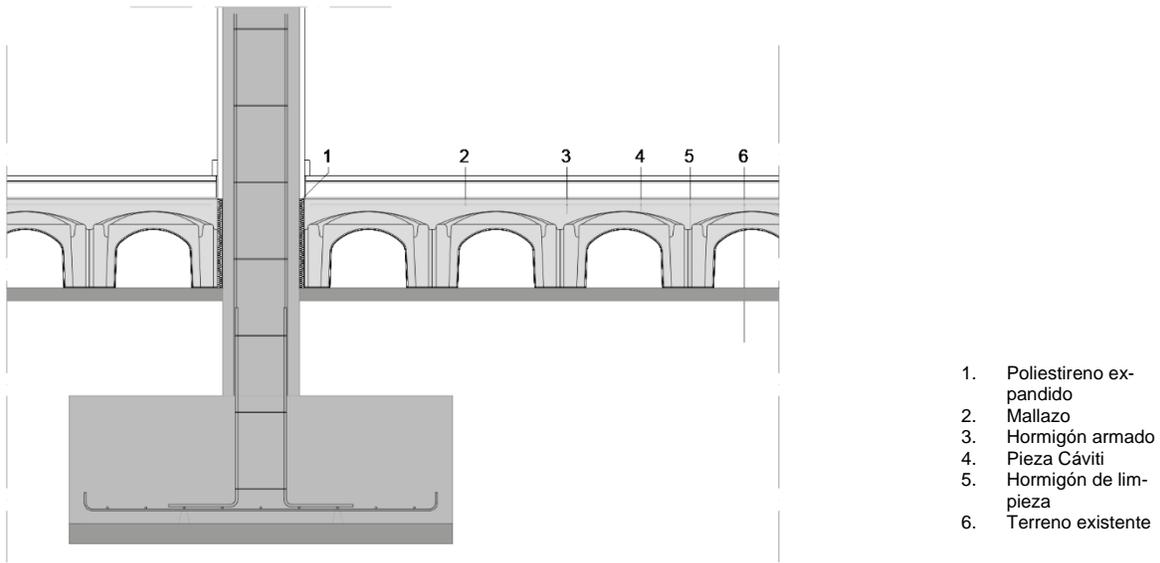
Detalle sistema Cáviti encuentro con pilar de hormigón.
